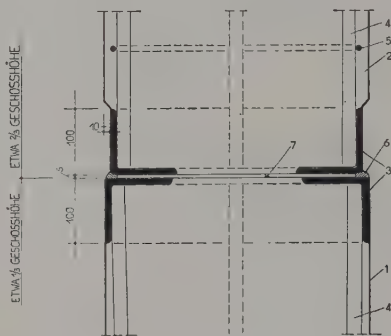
Ansicht des verschweißten Montagestoßes
